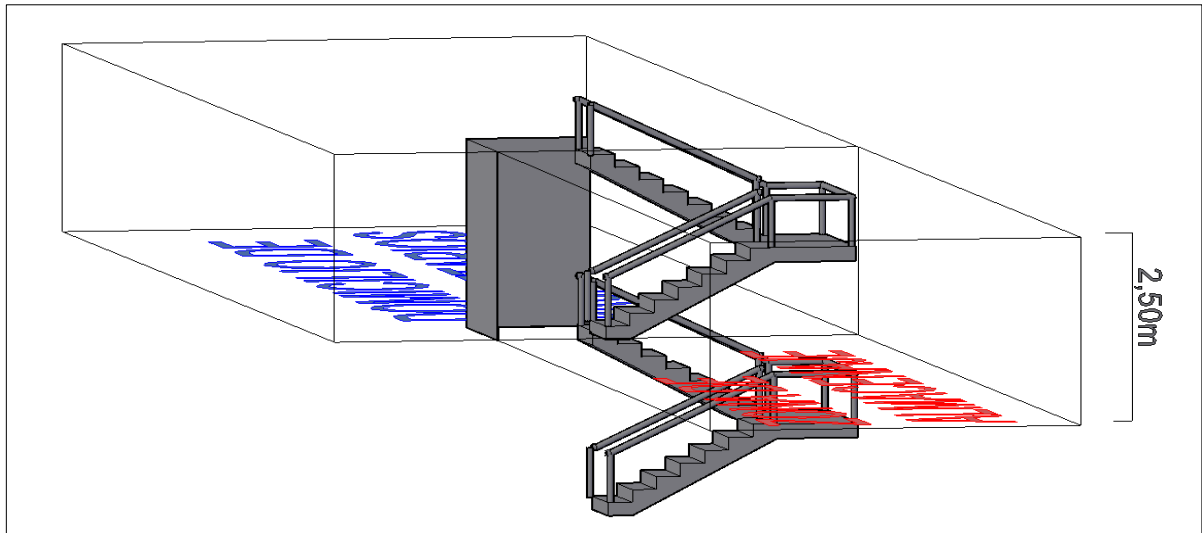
Vista lateral y dimensiones de la segunda planta (plano 2)
